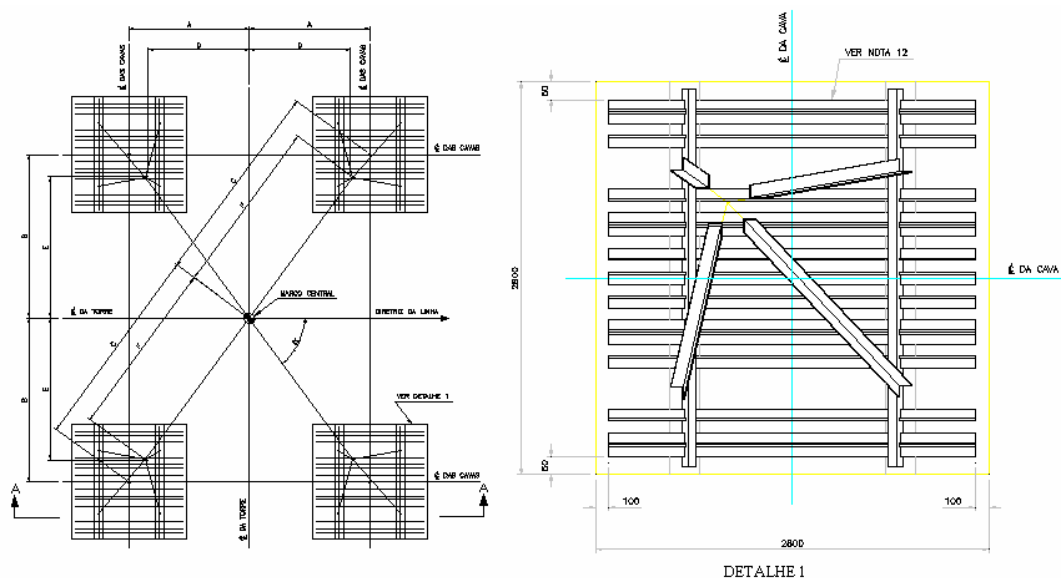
Planta e detalhe da fundação em grelha para torre autoportante de suspensão na LT Ivaiporã-Itaberá-Tijuco Preto.
